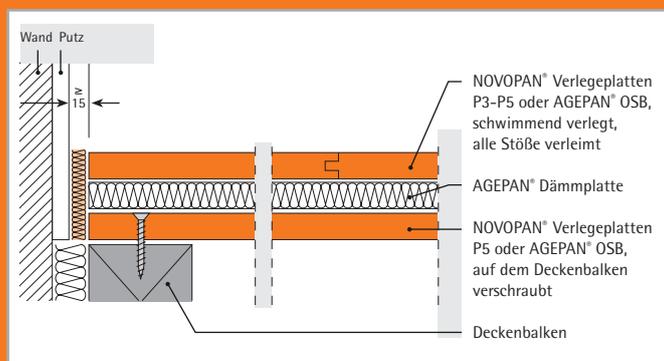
Das schwimmende Verlegen auf Holzbalkendecken mit AGEPAN® Dämmplatten.
